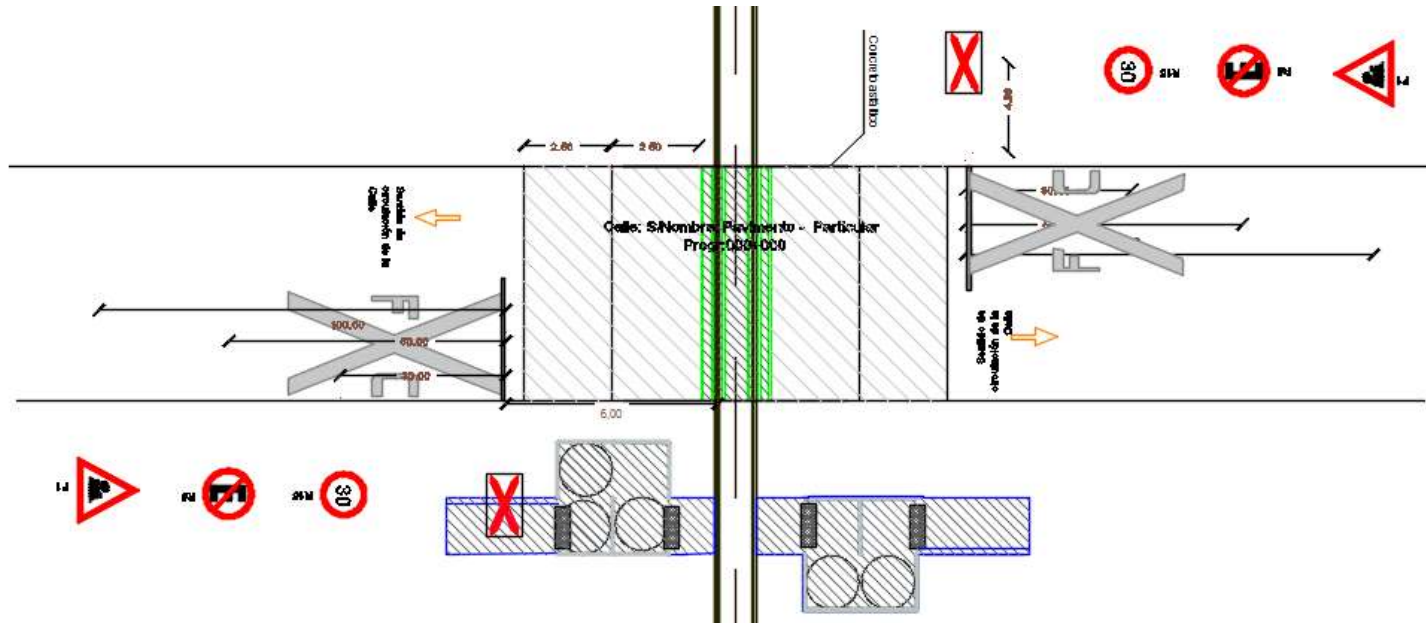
Planta de un Paso a Nivel pavimentado. Fuente: ADIFSE
